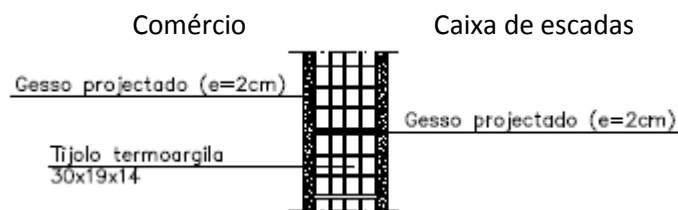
Pormenor construtivo da Pi1 [17]
